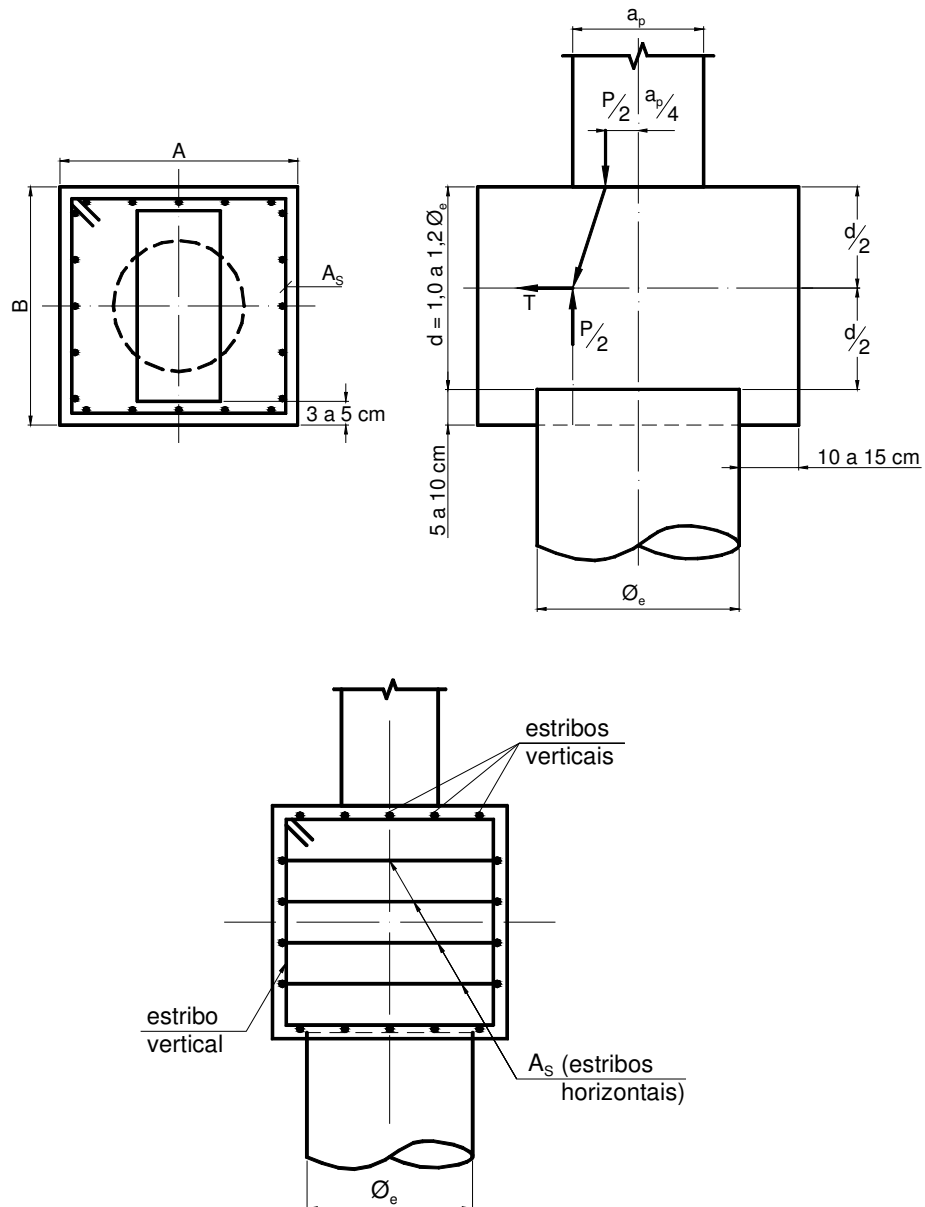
Bloco sobre uma estaca: esquema de forças e detalhes das armaduras.
